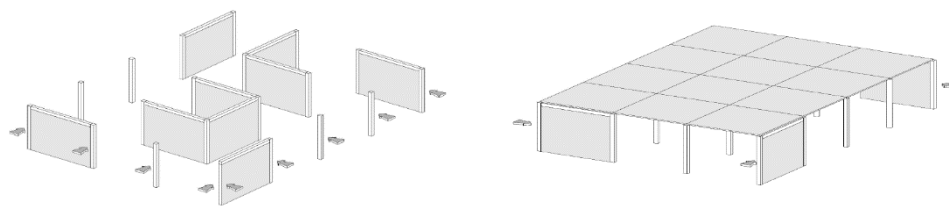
Contraventamento só nos painéis verticais e contraventamento nos painéis verticais e horizontais (Bignon & Critt-Crai, 2003).
